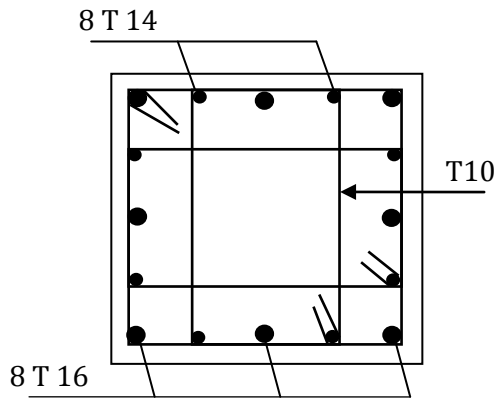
Schéma de ferrailage des poteaux 4<sup>ème</sup>, 5<sup>ème</sup> étage.
